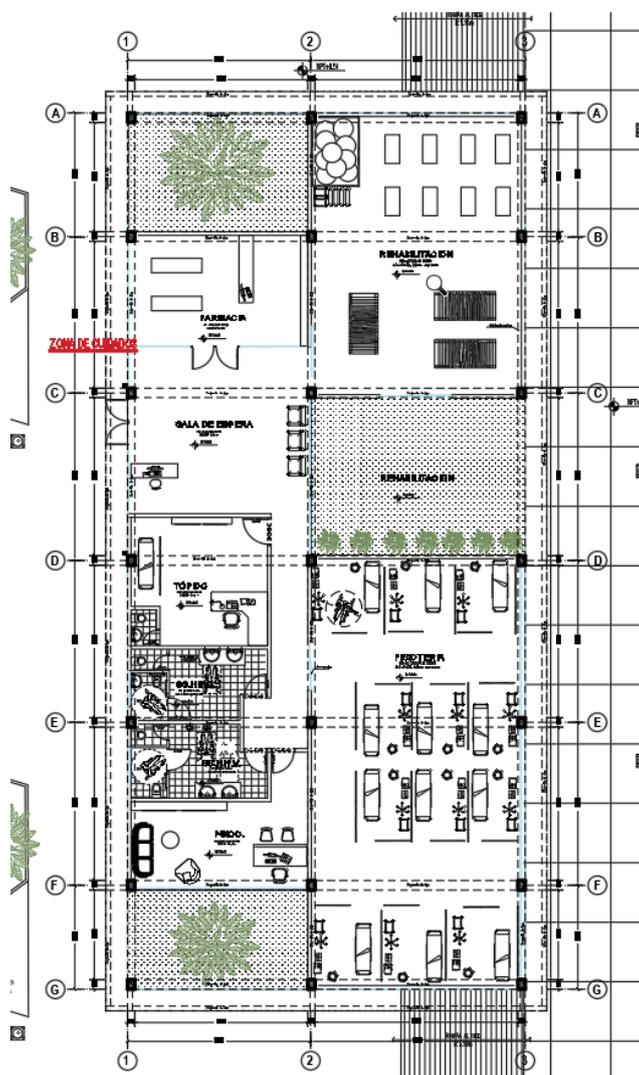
Distribución arquitectónica en planta del 1° piso, “Zona de Cuidados”
